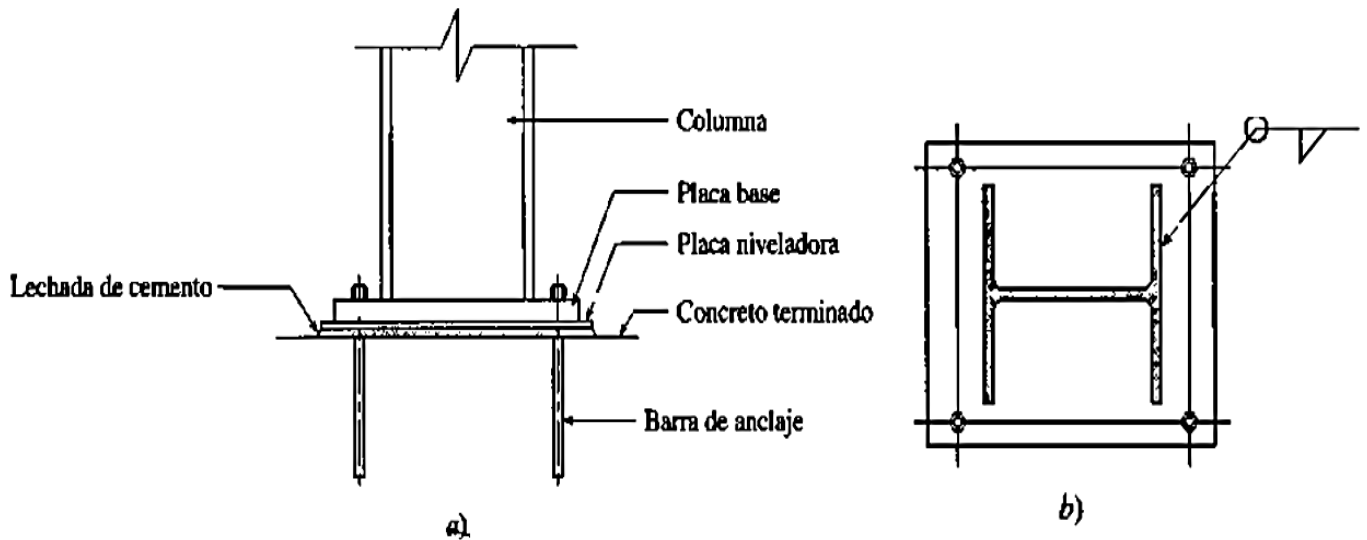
Detalle de placas base y pernos de anclaje para anclar columnas de acero a la cimentación
